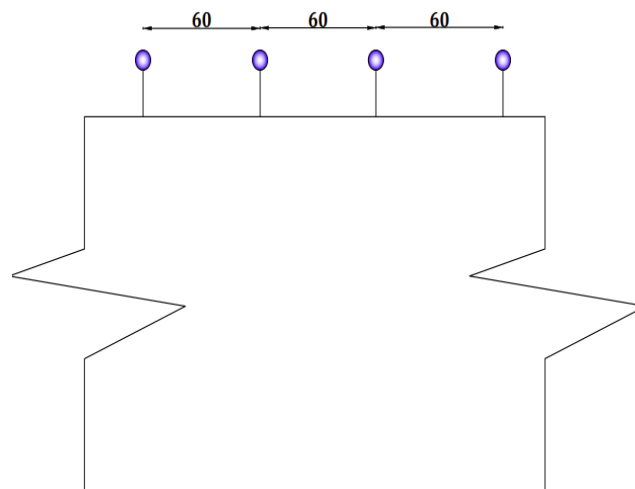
DISPOSITION LONGITUDINALE DES GOUDJONS SUR LA POUTRE
